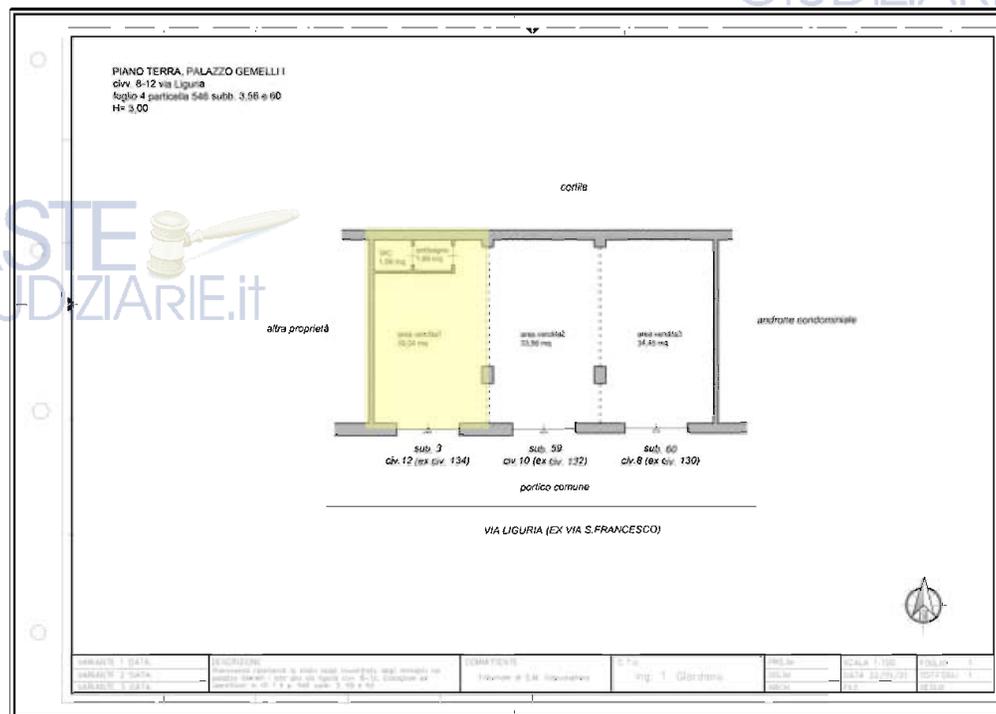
Pianta del minimarket con evidenziazione del LOTTO1
